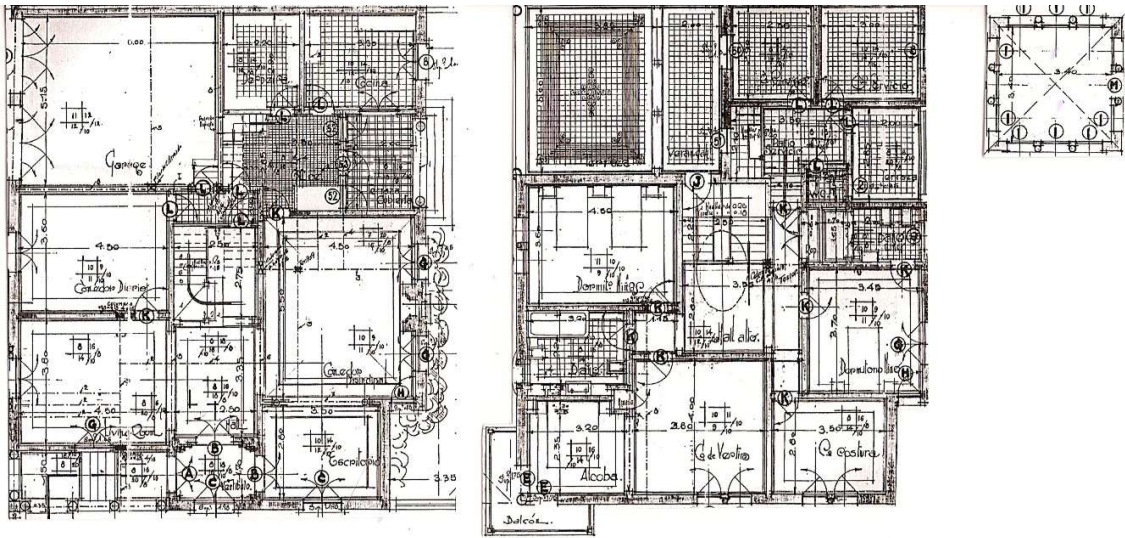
Bello & Reborati, Casa Bello, Plans, rez-de-chaussée (gauche), premier étage (droite) Montevideo, 1930 (CDI-IHA, FADU, Udelar)
